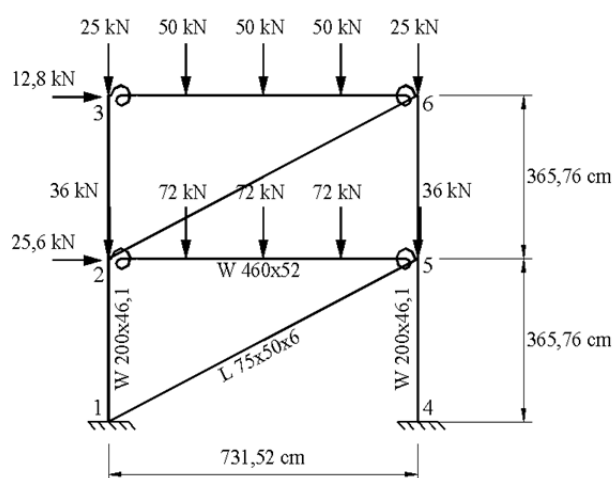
Pórtico contraventado de dois andares e um vão.
